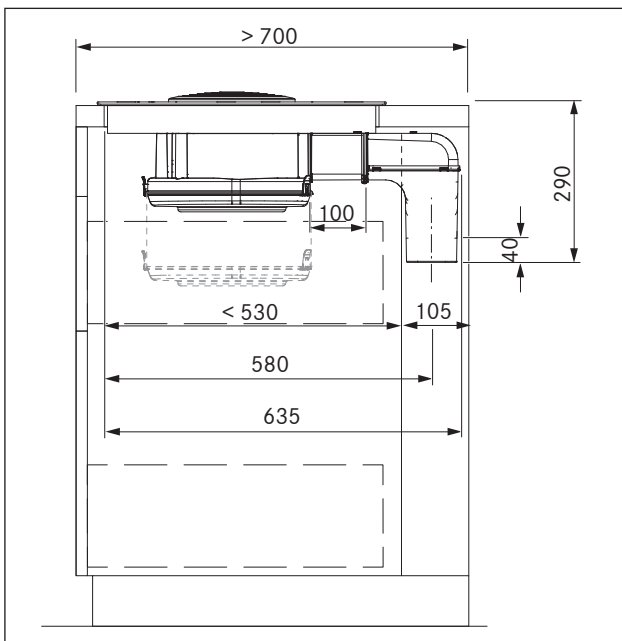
Dimensiones de montaje en aire de salida, profundidad de la encimera 700 mm
